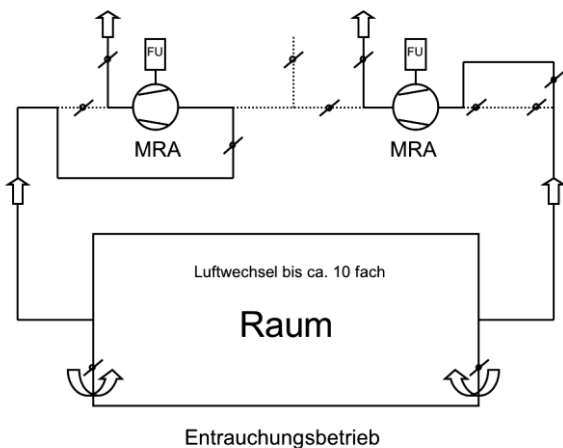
Anlagenschema einer Lüftungsanlage im Entrauchungsbetrieb mit zwei Entrauchungsleitungen
